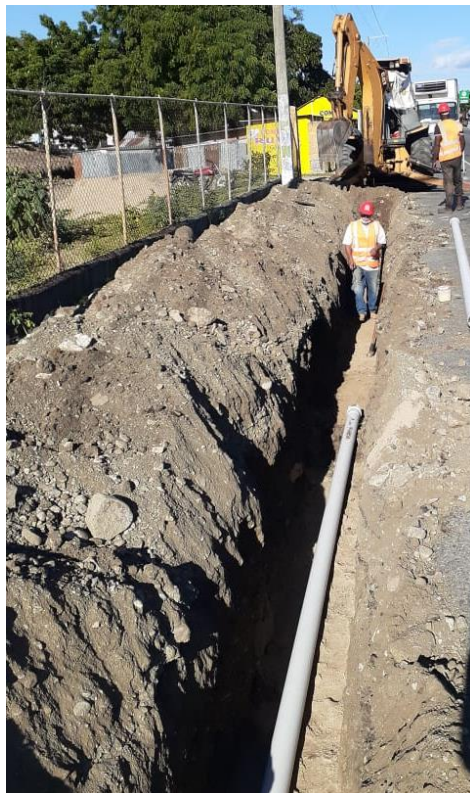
Instalación de Tuberías 6" PVC (SDR26) – Sector Rio Arriba
